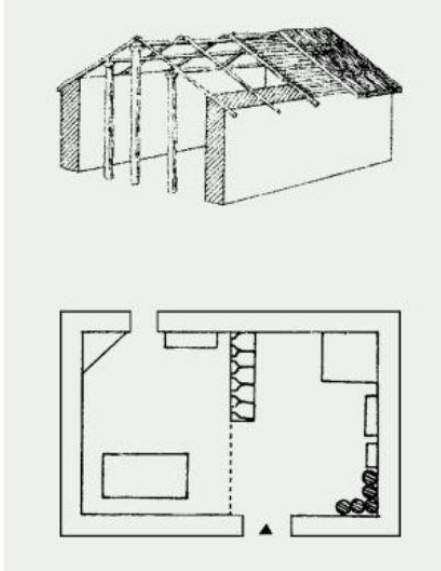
planta y alzado casa elemental en la región de Ouarsenis , Argelia.
